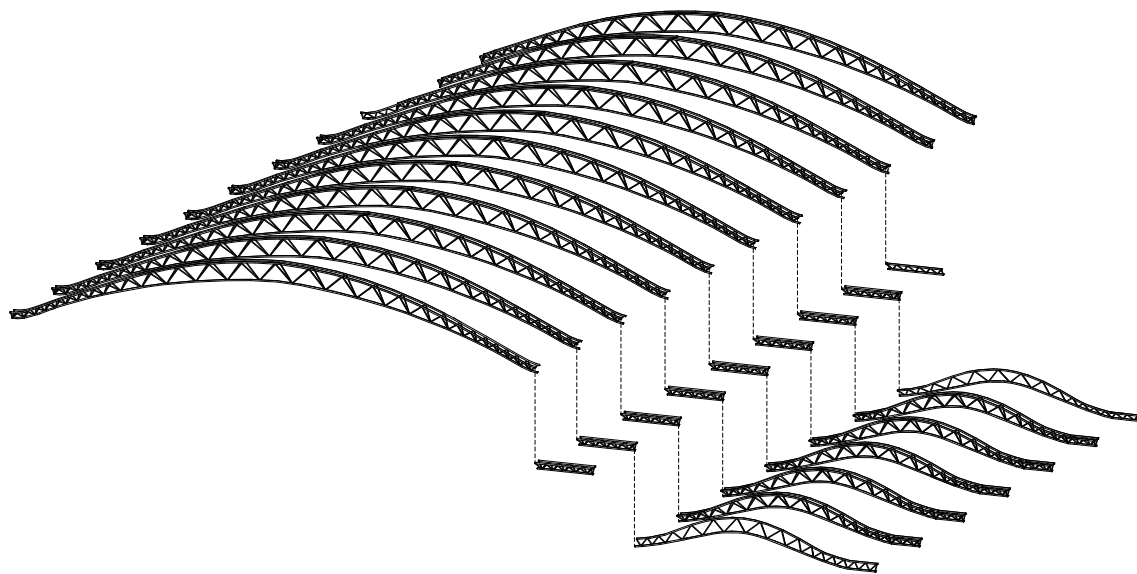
Explosionszeichnung Segmente Primärtragwerk
